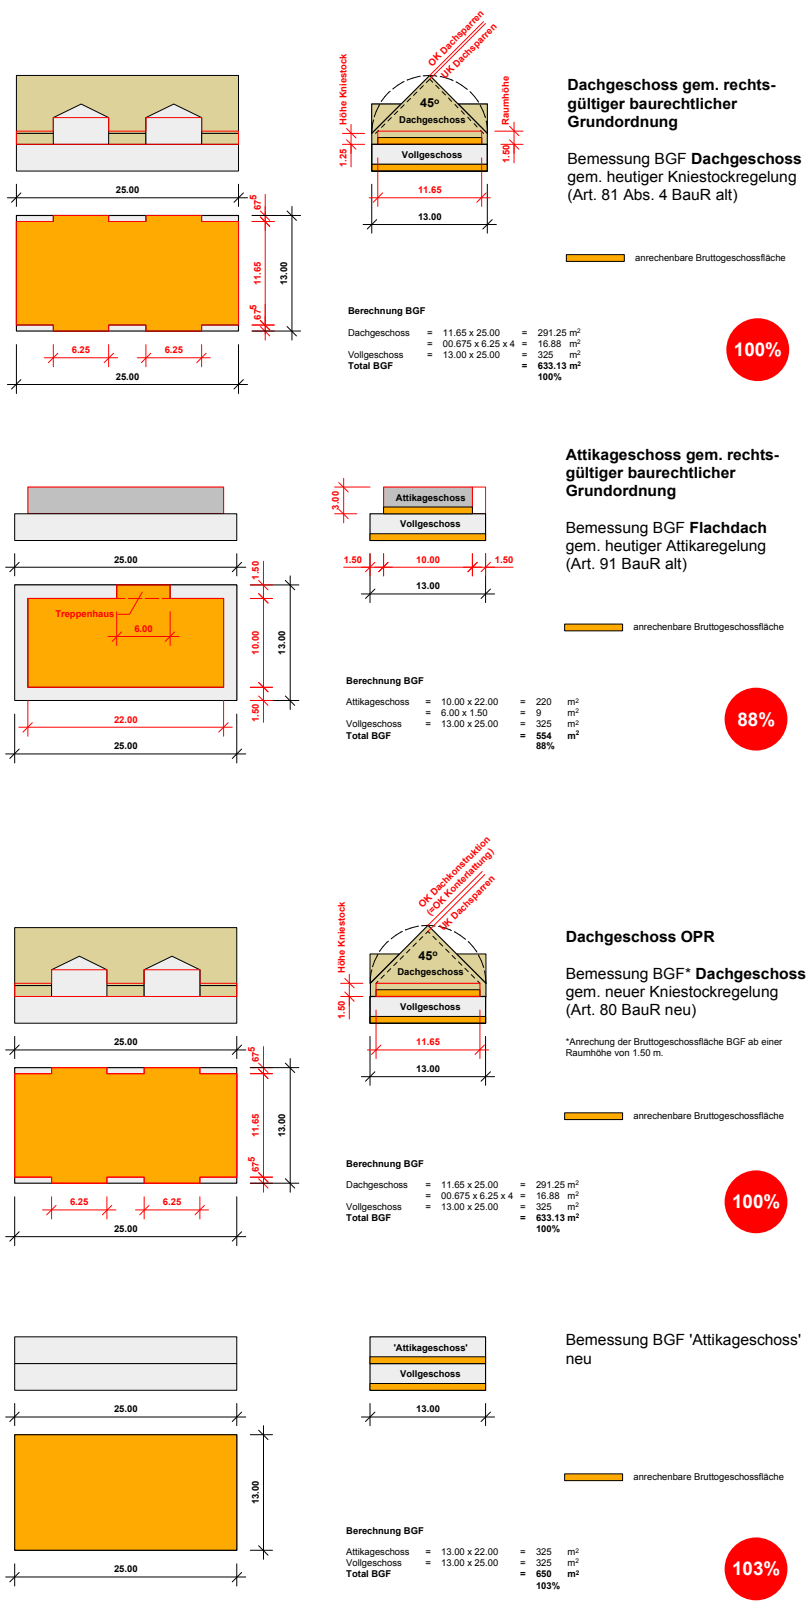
Vergleich der möglichen Nutzung zwischen Schrägdach und Flachdach gemäss rechtsgültiger baurechtlicher Grundordnung (oben) und der baurechtlichen Grundordnung gemäss Ortsplanungsrevision (unten).
